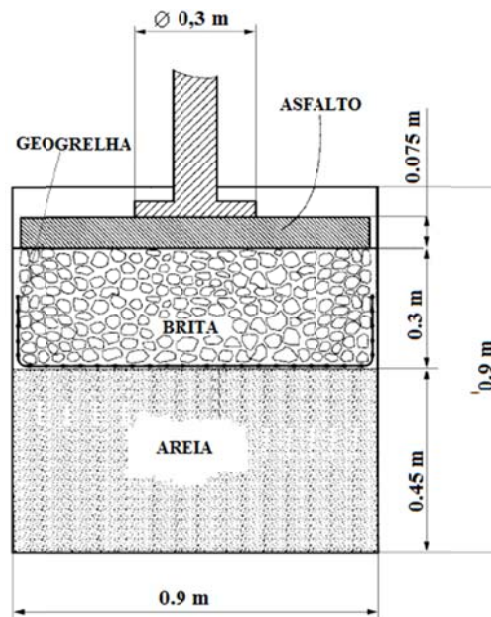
Caixa metálica usada por Cancelli para simulação de uma estrada não pavimentada (modificado - Cancelli et al, 1996).
